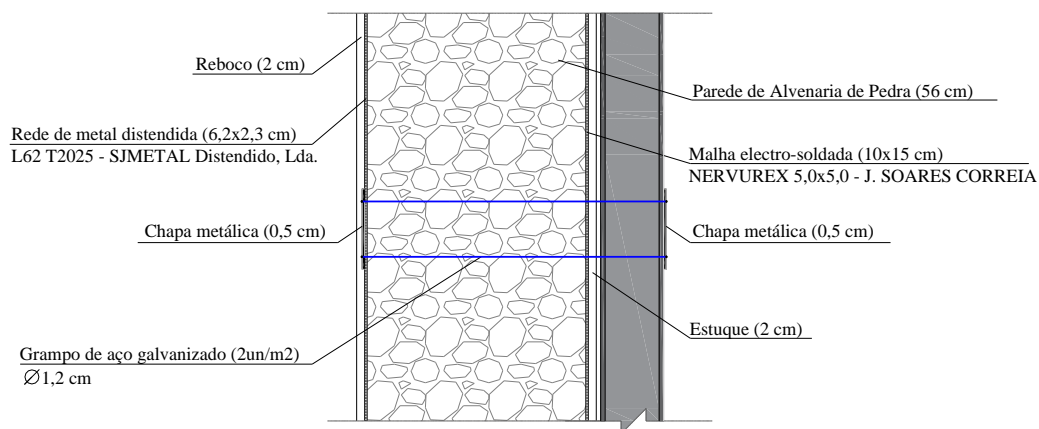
Método de ligação das paredes de fachada antigas à nova estrutura
